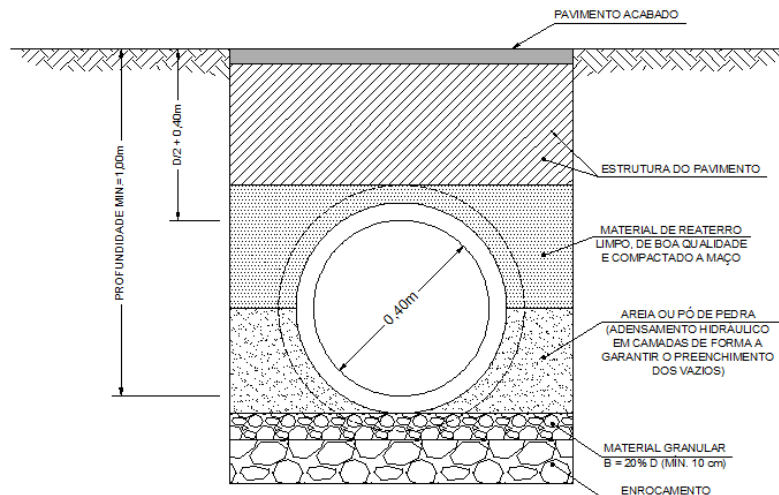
Detalhe do assentamento de Tubo (D=0,40m)
